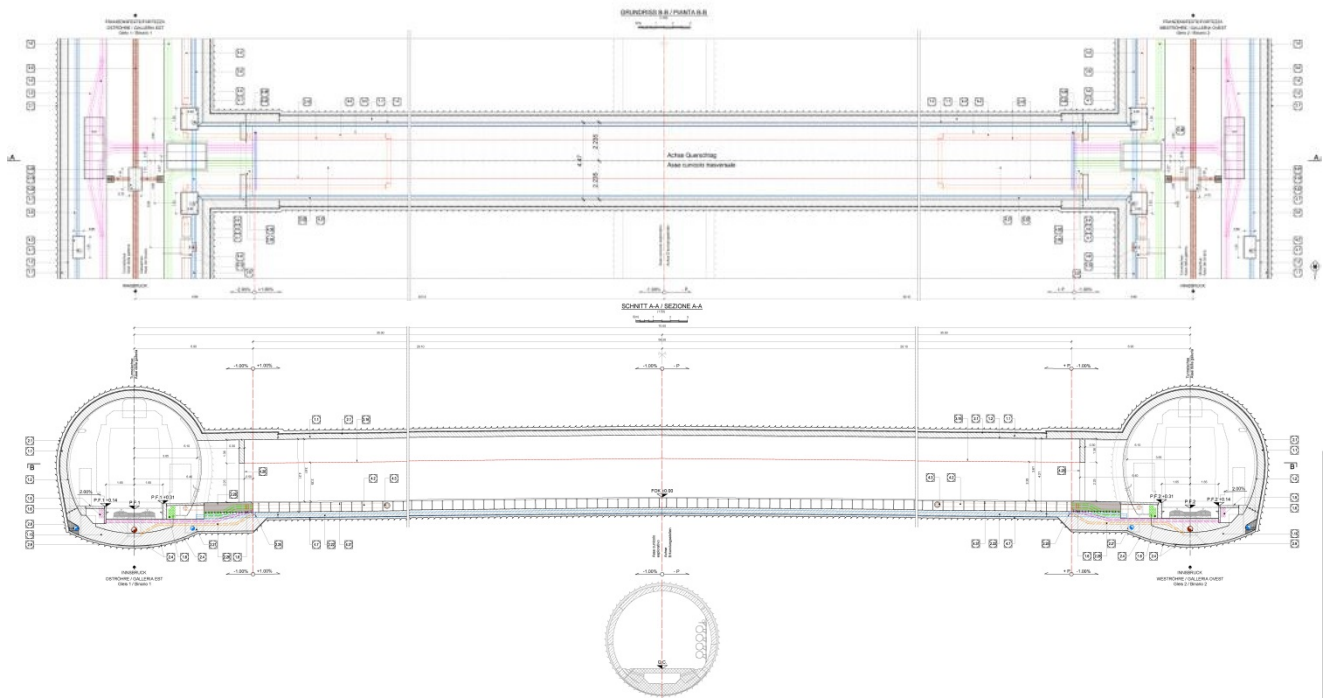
Querschlag Typ 1 - A) Lageplan, B) Längenschnitt mit doppelter Neigung [61]
